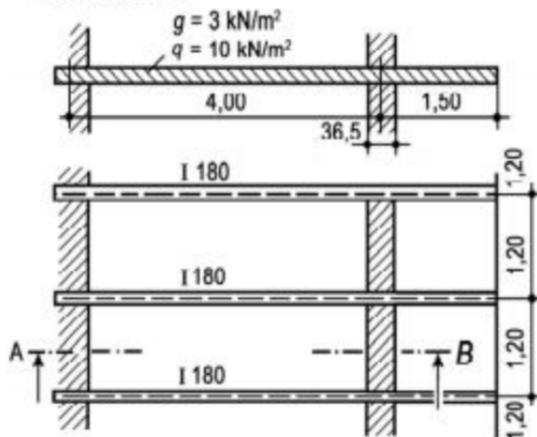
Stahlbetondecke zwischen I 180 mit Laderampe
